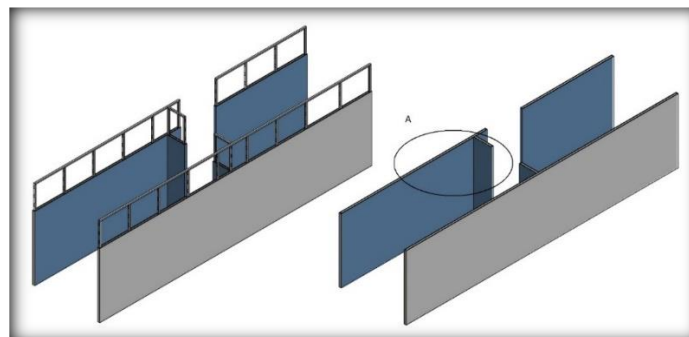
Vista con subestructura elevada para mostrar colocación y vista ya colocada
